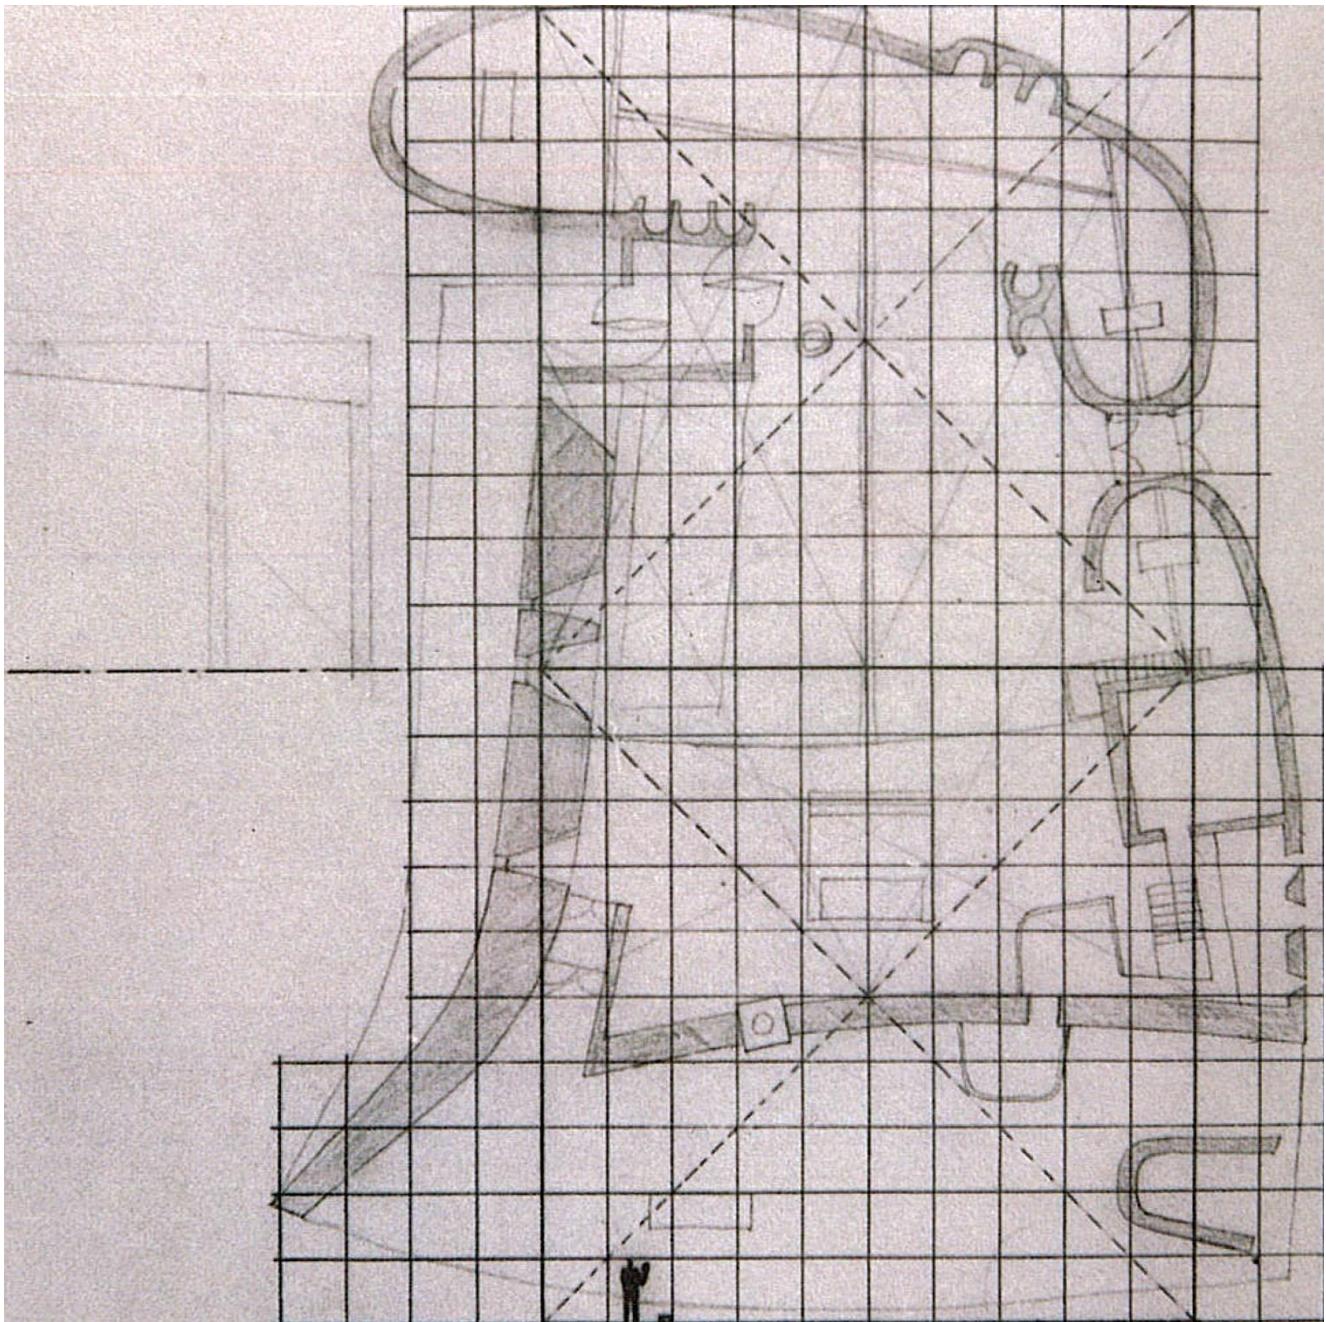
Planimetria di Ronchamp con il riferimento allo schema geometrico della ricostruzione del Tabernacolo degli Ebrei.
